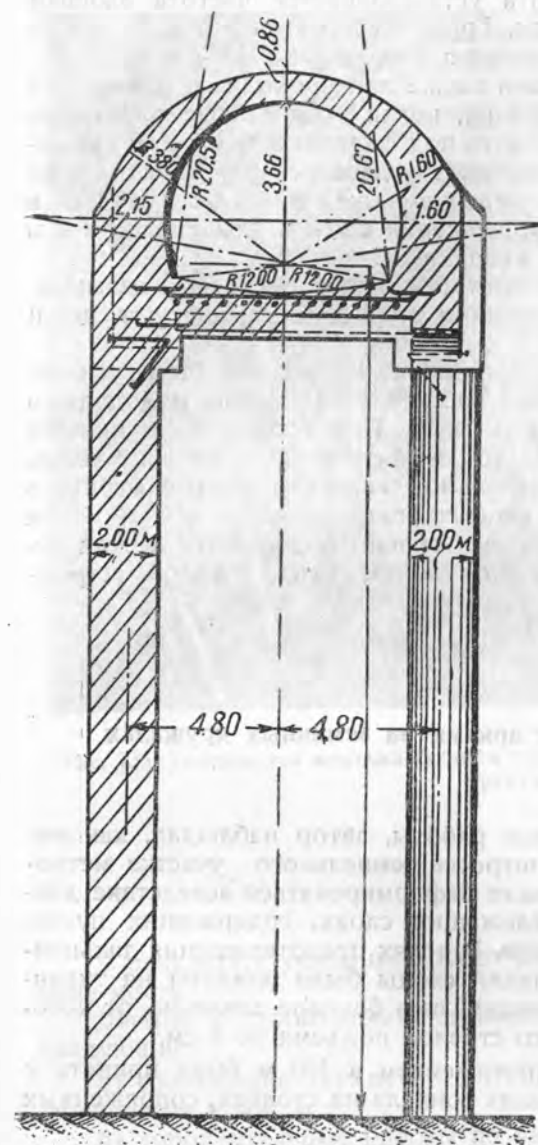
Конструкция двухпутного тоннеля-моста, опоры которых сооружены в колодцах.
